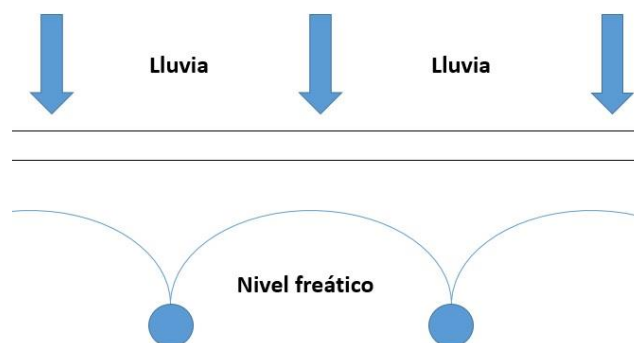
Sistema de drenaje subterráneo por drenes enterrados.
